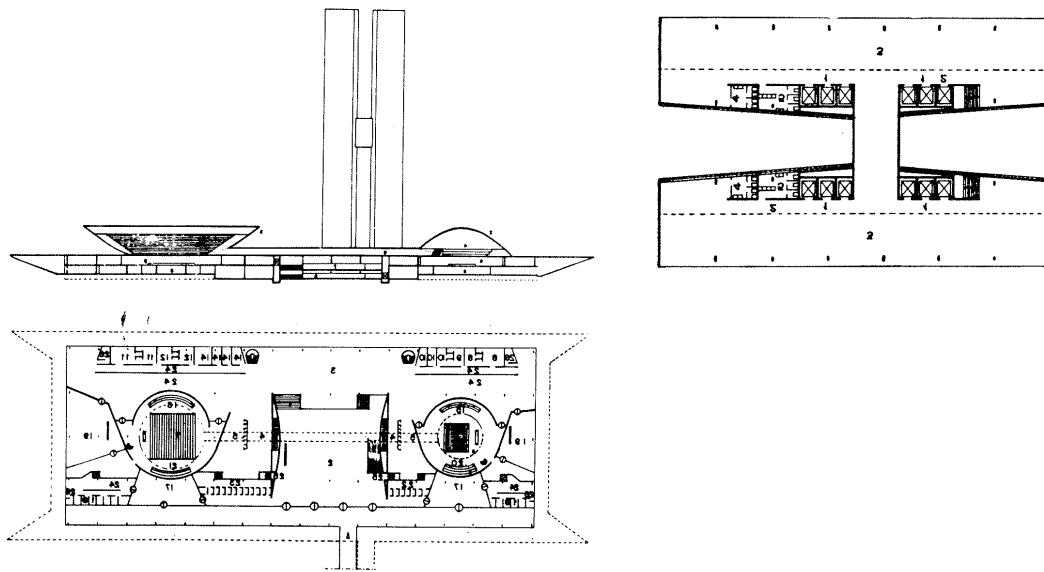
Oscar Niemeyer, *Congresso Nacional* und Annex I, Aufriss, Grundriss Annex I und Grundriss Obergeschoss.
